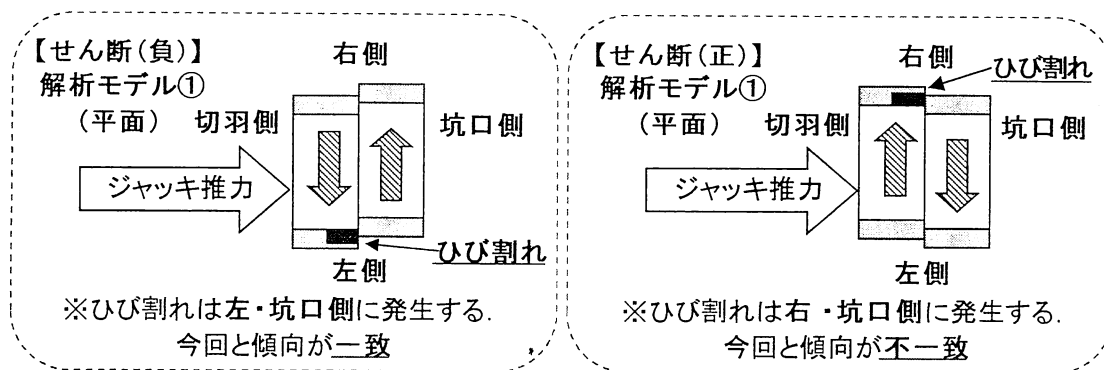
解析モデル①(平面) ひび割れ発生箇所の整合性の確認
